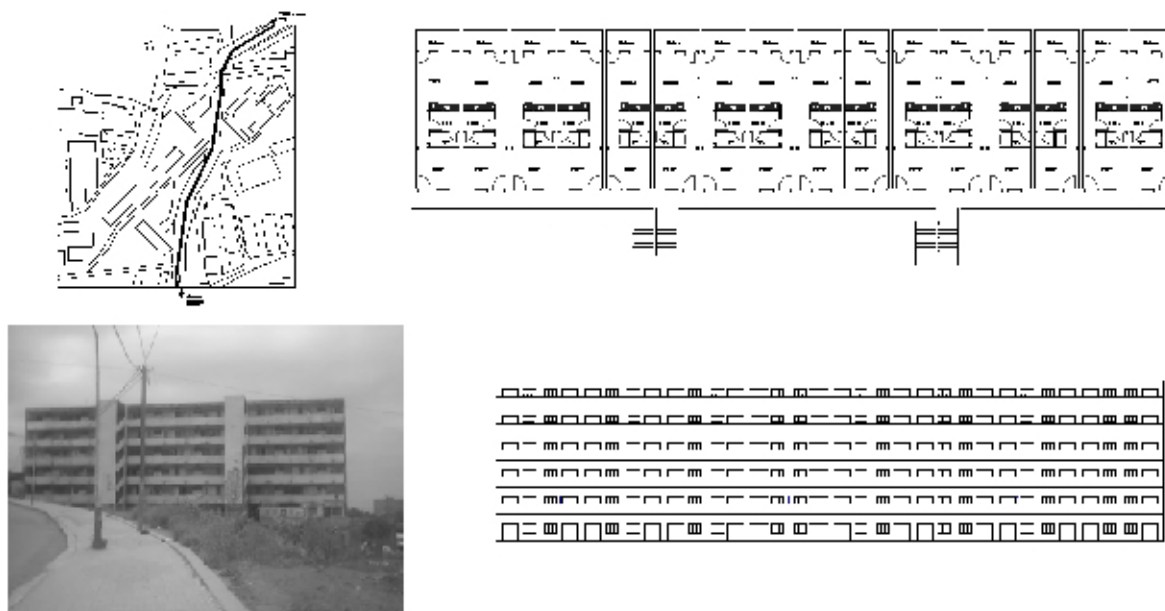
4.1.4 : Cite Belle Vue : 1- Situation – 2- Plan de cellule – 3 vue sur la cite – 4 Façade
